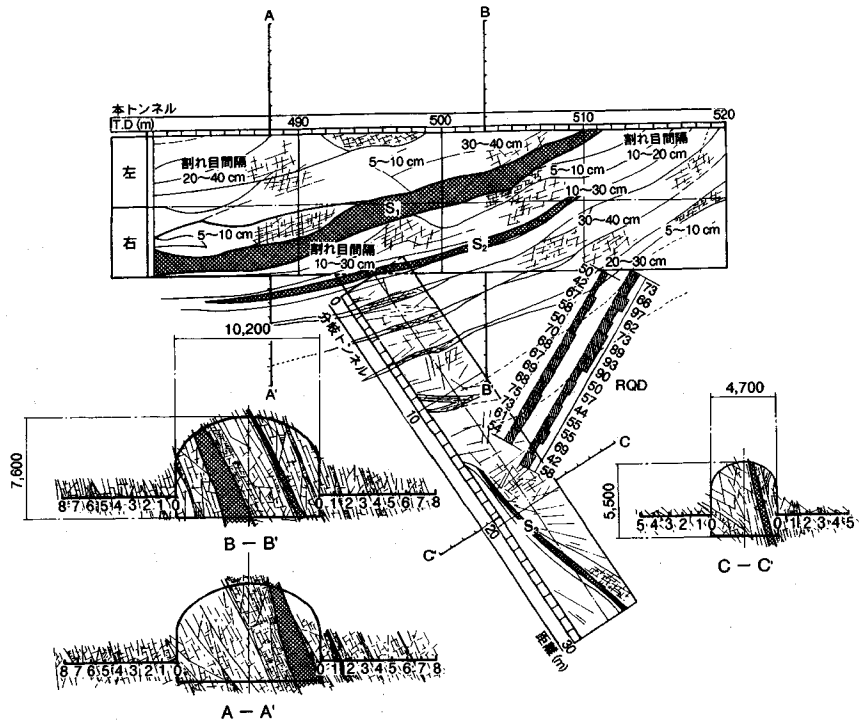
調査トンネル交差部付近の地質平面図と断面図，水平ボーリングコアのRQD
